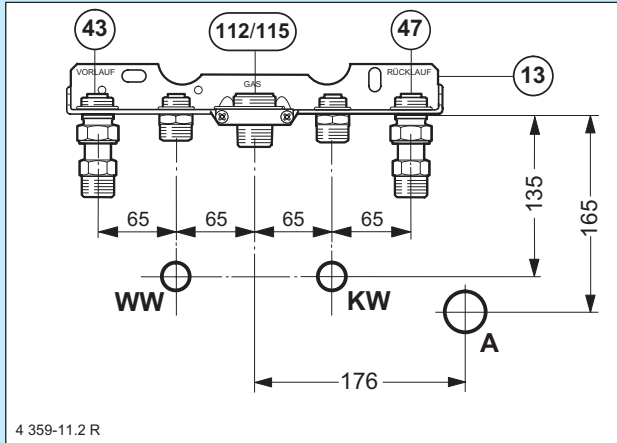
Aufputzanschlüsse mit Wandabstand 60 mm
